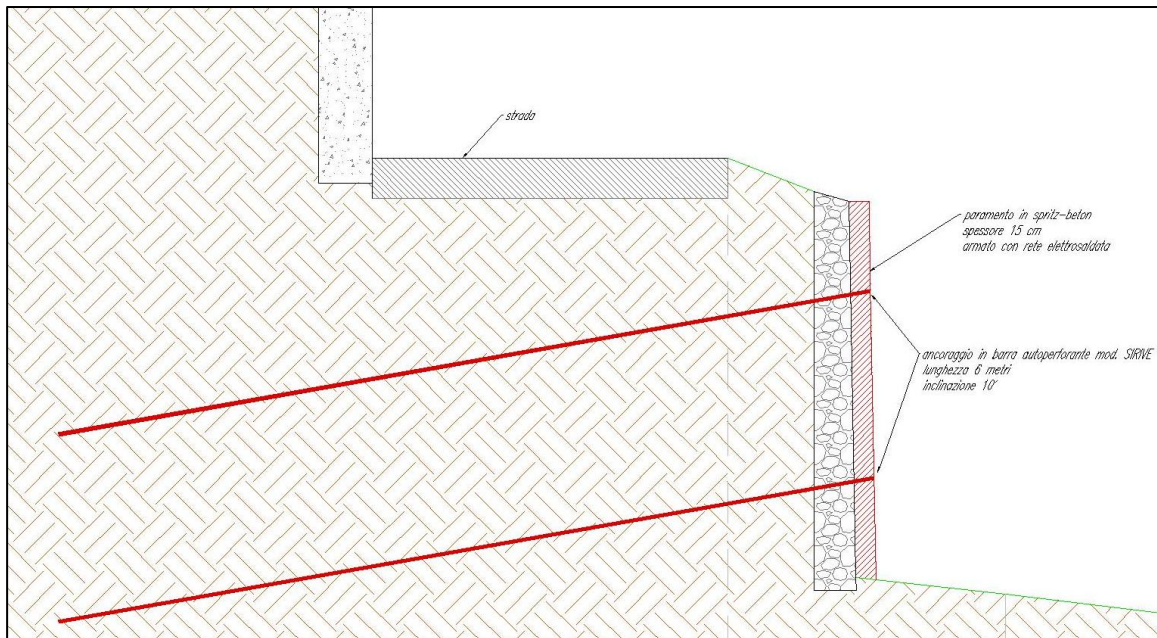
Sezione tipo dell'intervento nel sito "Pedalto Est"
